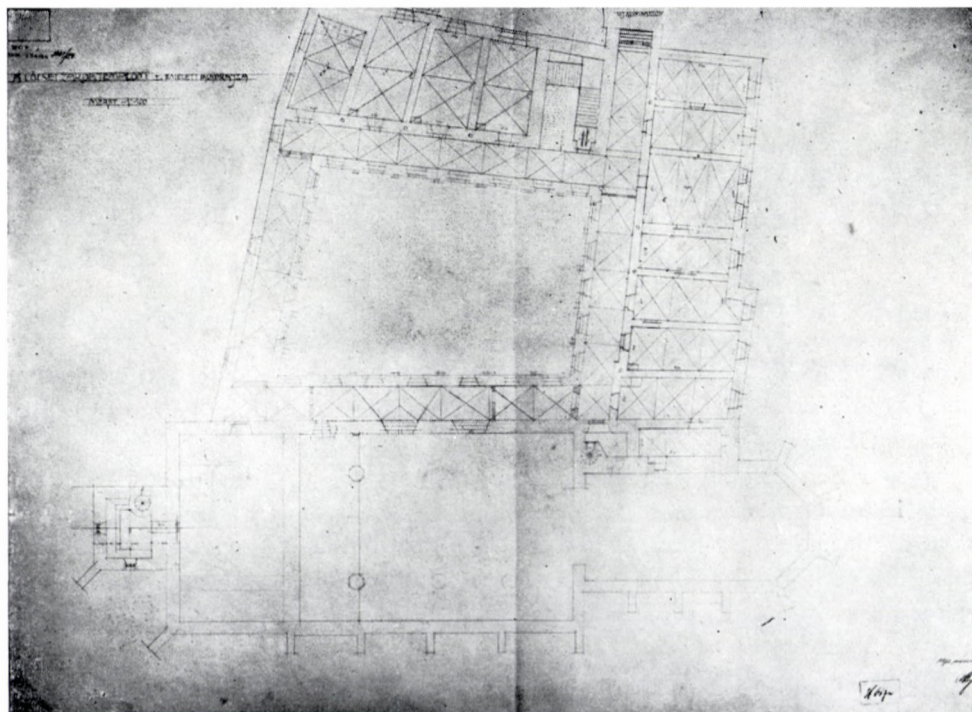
Kirche und Kreuzgang. Grundriß 1. Stock. OMF
